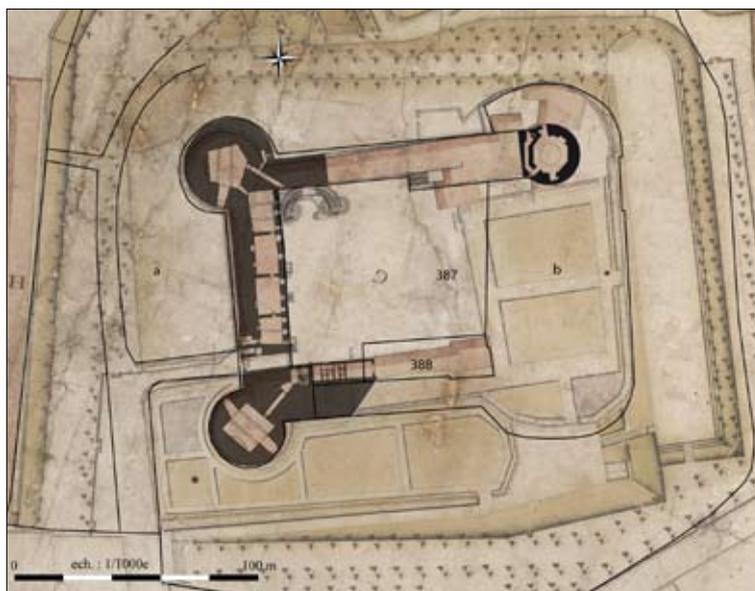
Pontivy, château des Rohan. Recalage au 100° des plans de la tour nord-est, du plan topographique du château et du cadastre actuel, sur le plan de 1781 (DAO Jocelyn Martineau, d'après Yannick Rose, 1987, le cadastre actuel et le plan des Archives municipales Pontivy, 5 Fi 1)
